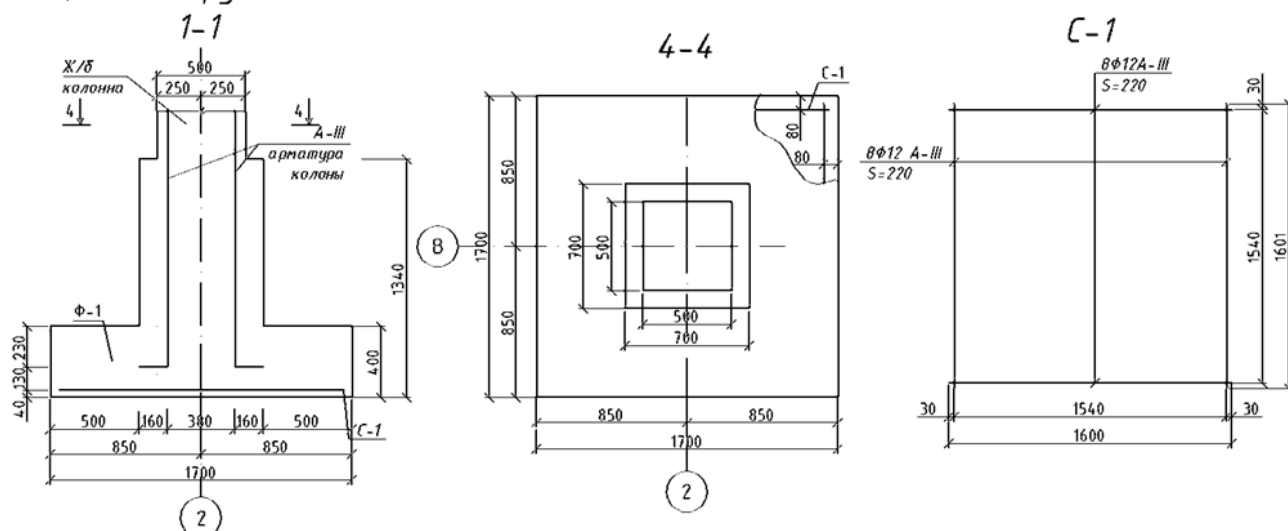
Конструкция фундамента колонны сечением 500х500
